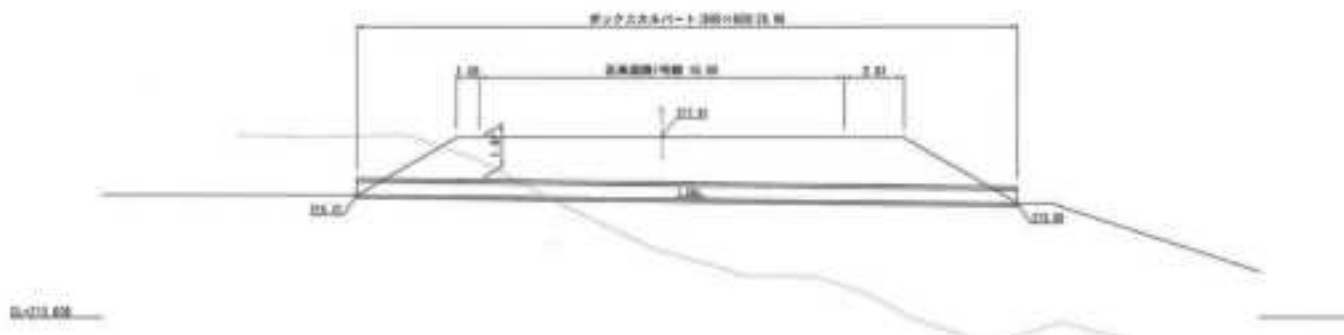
(4) アンダーパス断面図 (イメージ)
